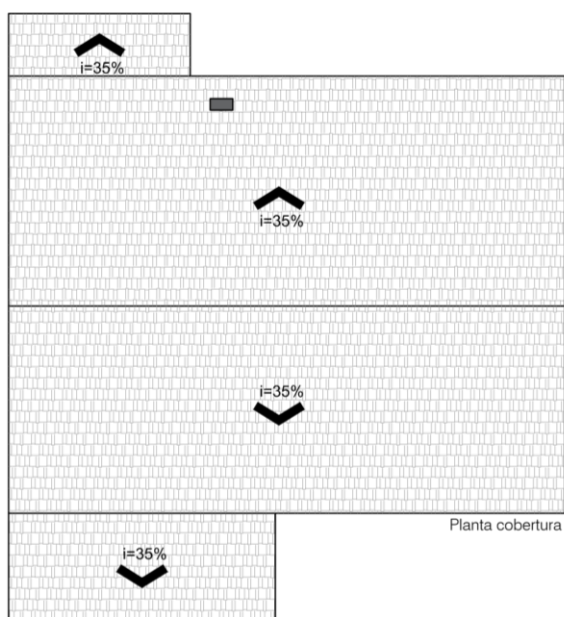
Tipo A-1 Variante – área total: 70,17m²
